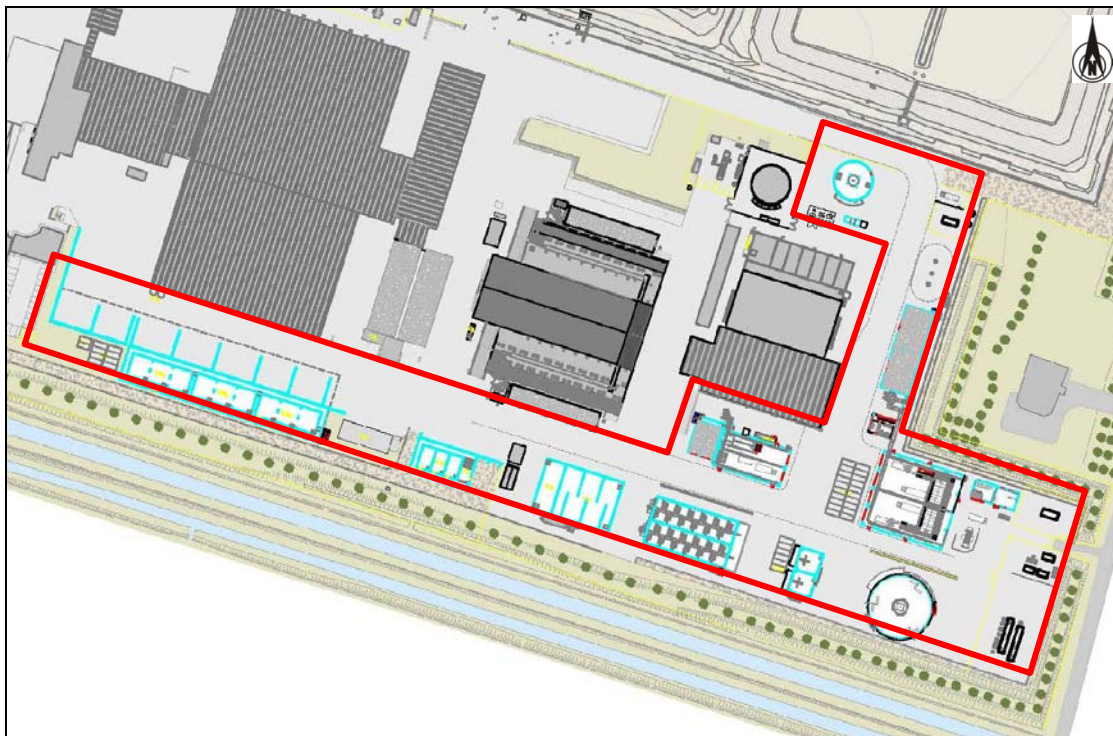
Planimetria di dettaglio progettuale dell'intervento in progetto.
